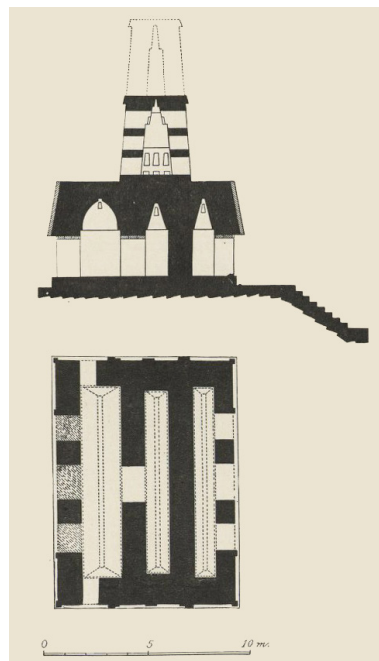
Planta y sección de la Estructura 6 de Yaxchilán según Teobert Maler (1903).
